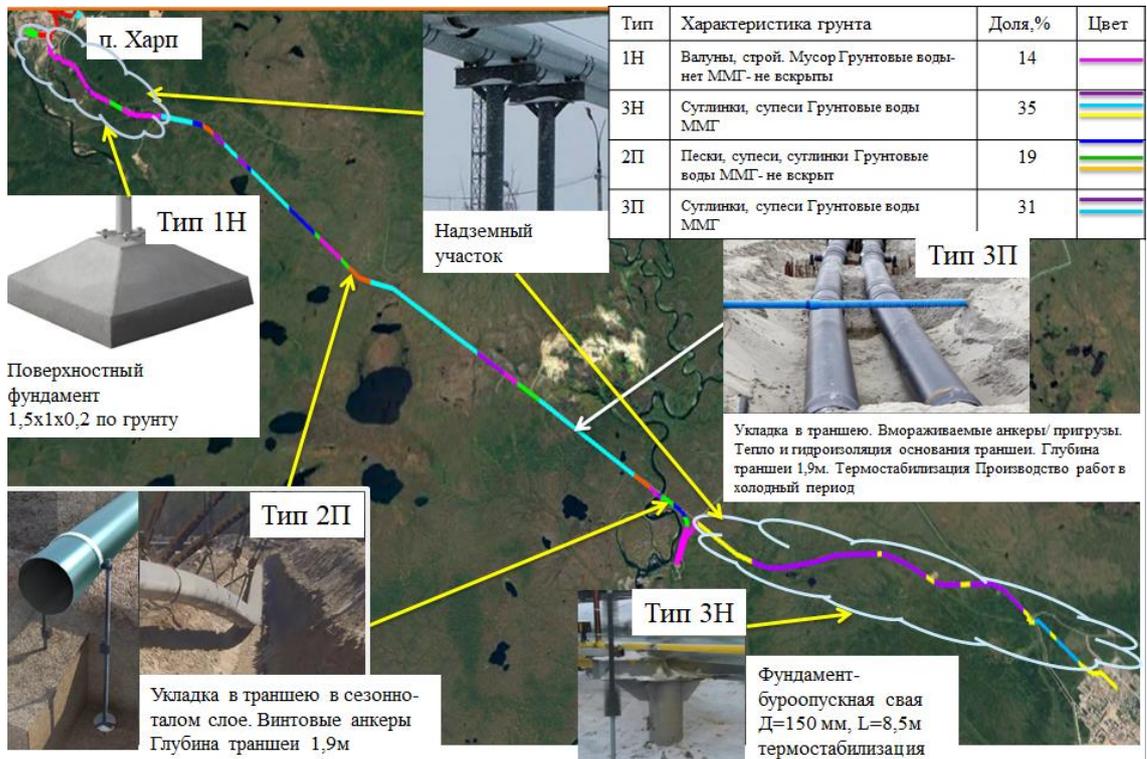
Схема прокладки водопровода для Варианта 2
